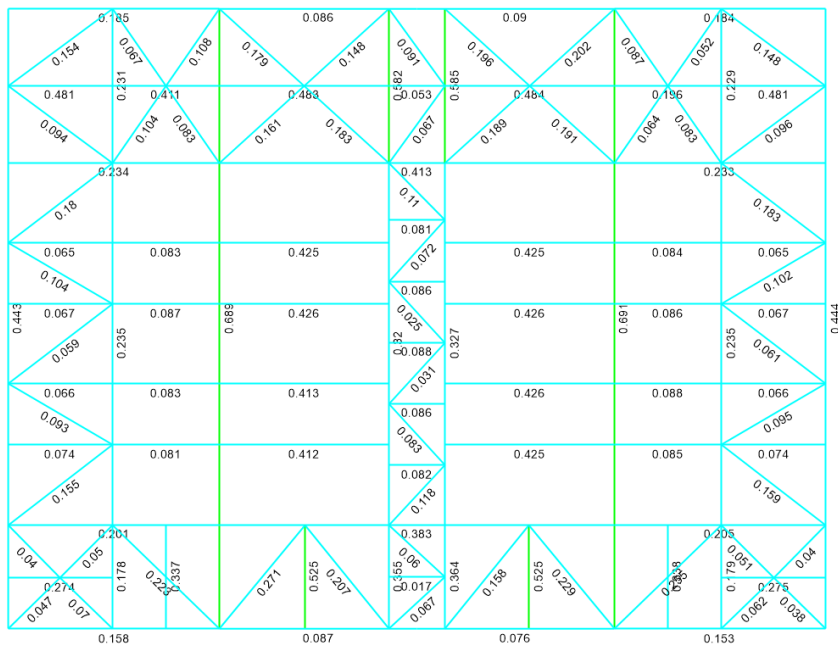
Factores de utilización planta segundo nivel para cargas de diseño LRFD.
